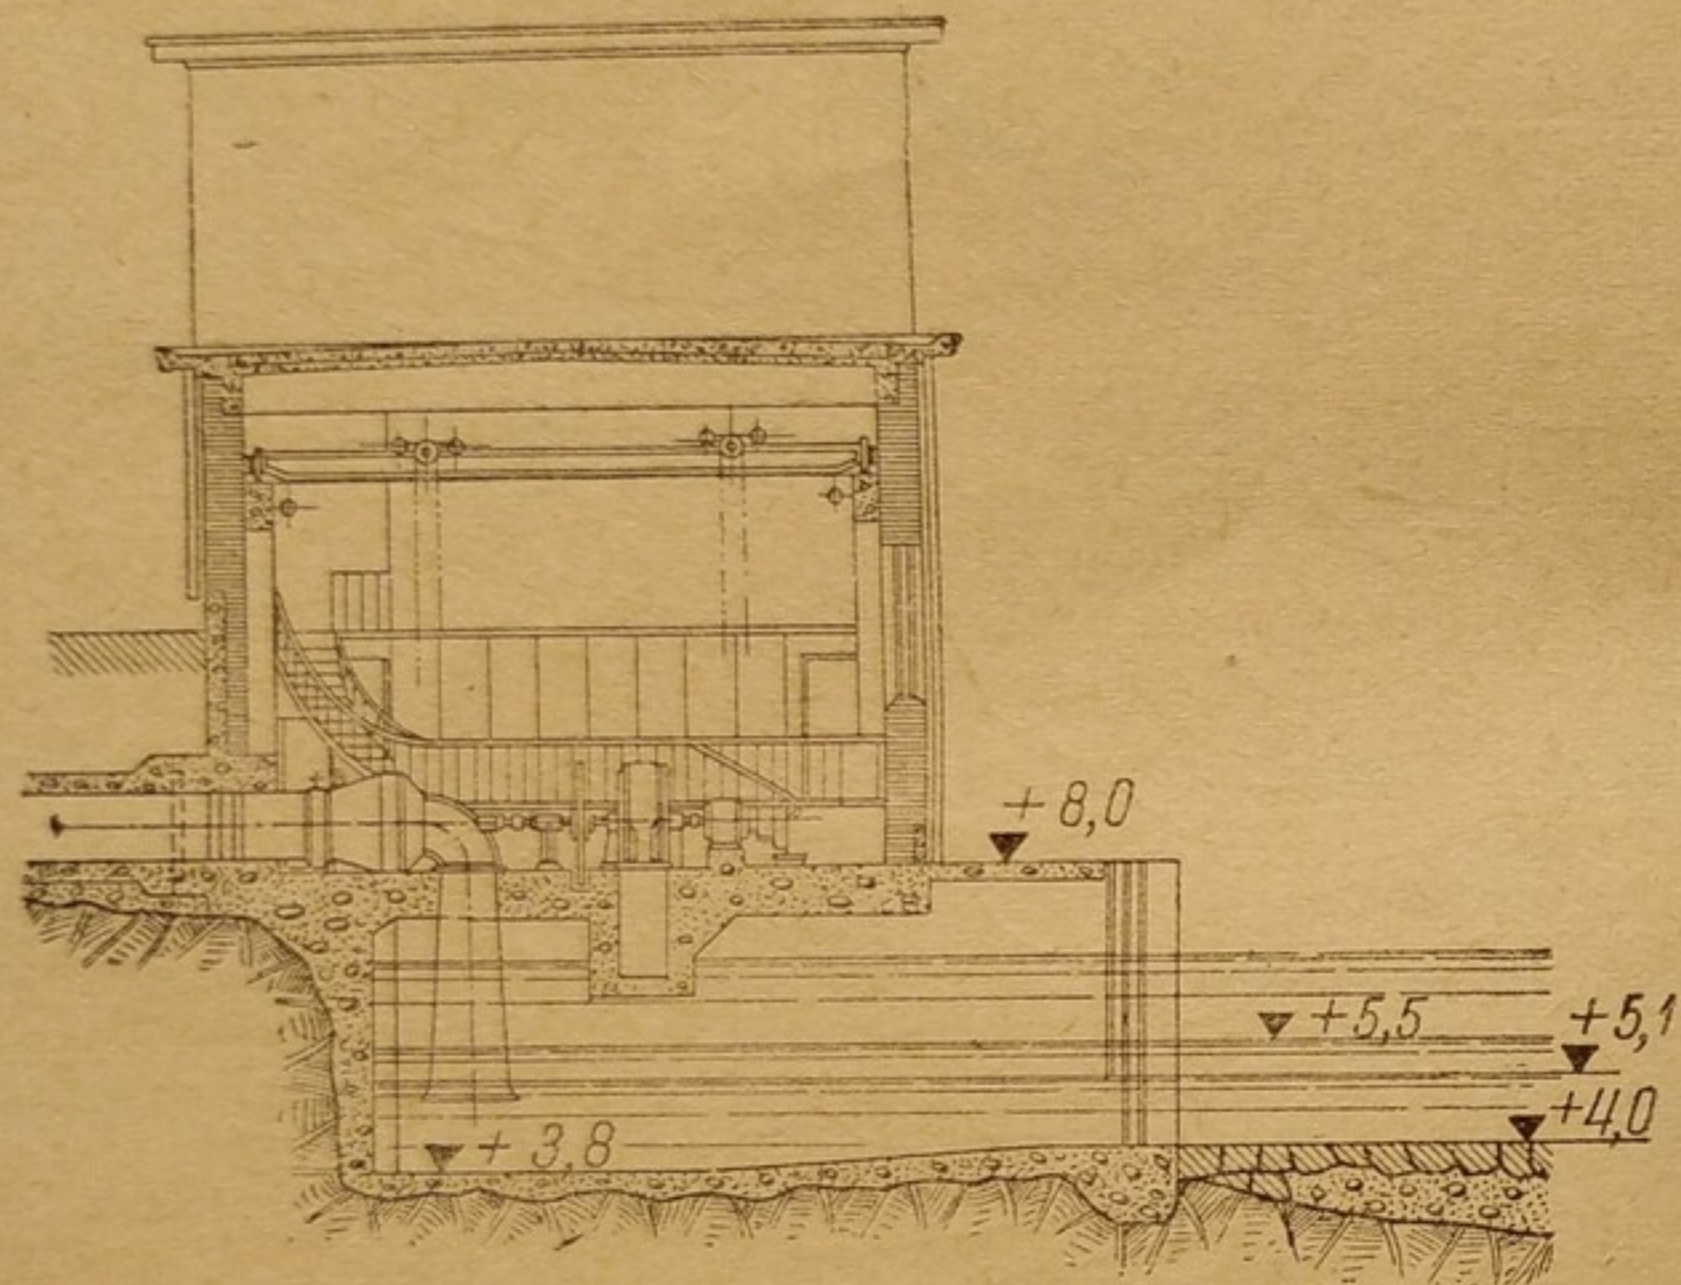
Поперечный разрез здания станции Питкякоскен по проекту.
